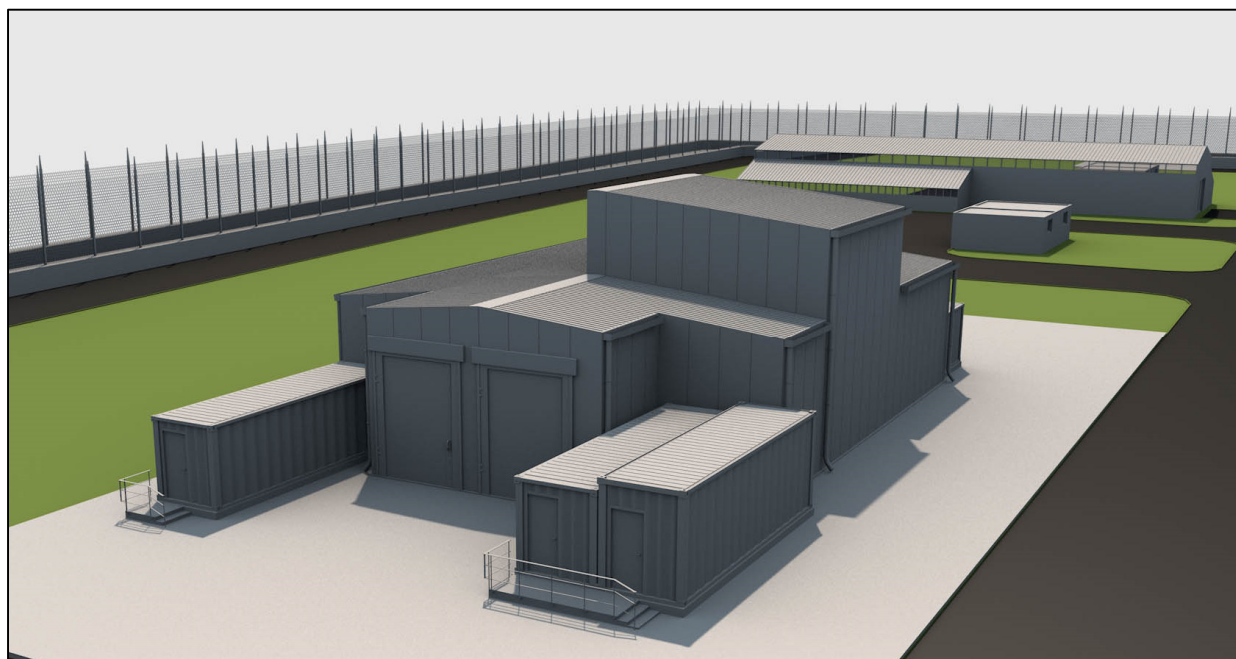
Impianto SiCoMoR – prospetto Nord - Ricostruzione 3D
